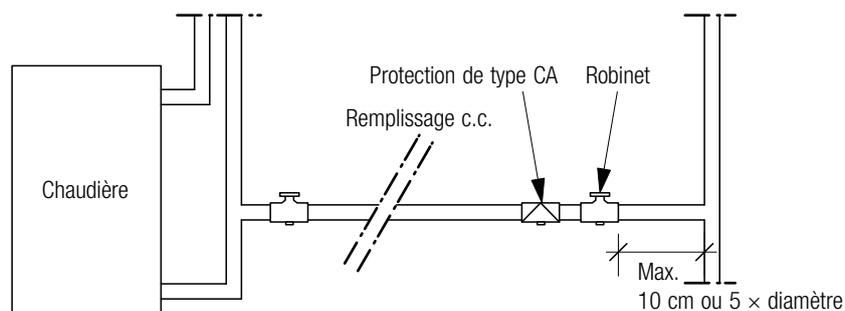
Protection de la conduite de remplissage de l'installation de chauffage central.
